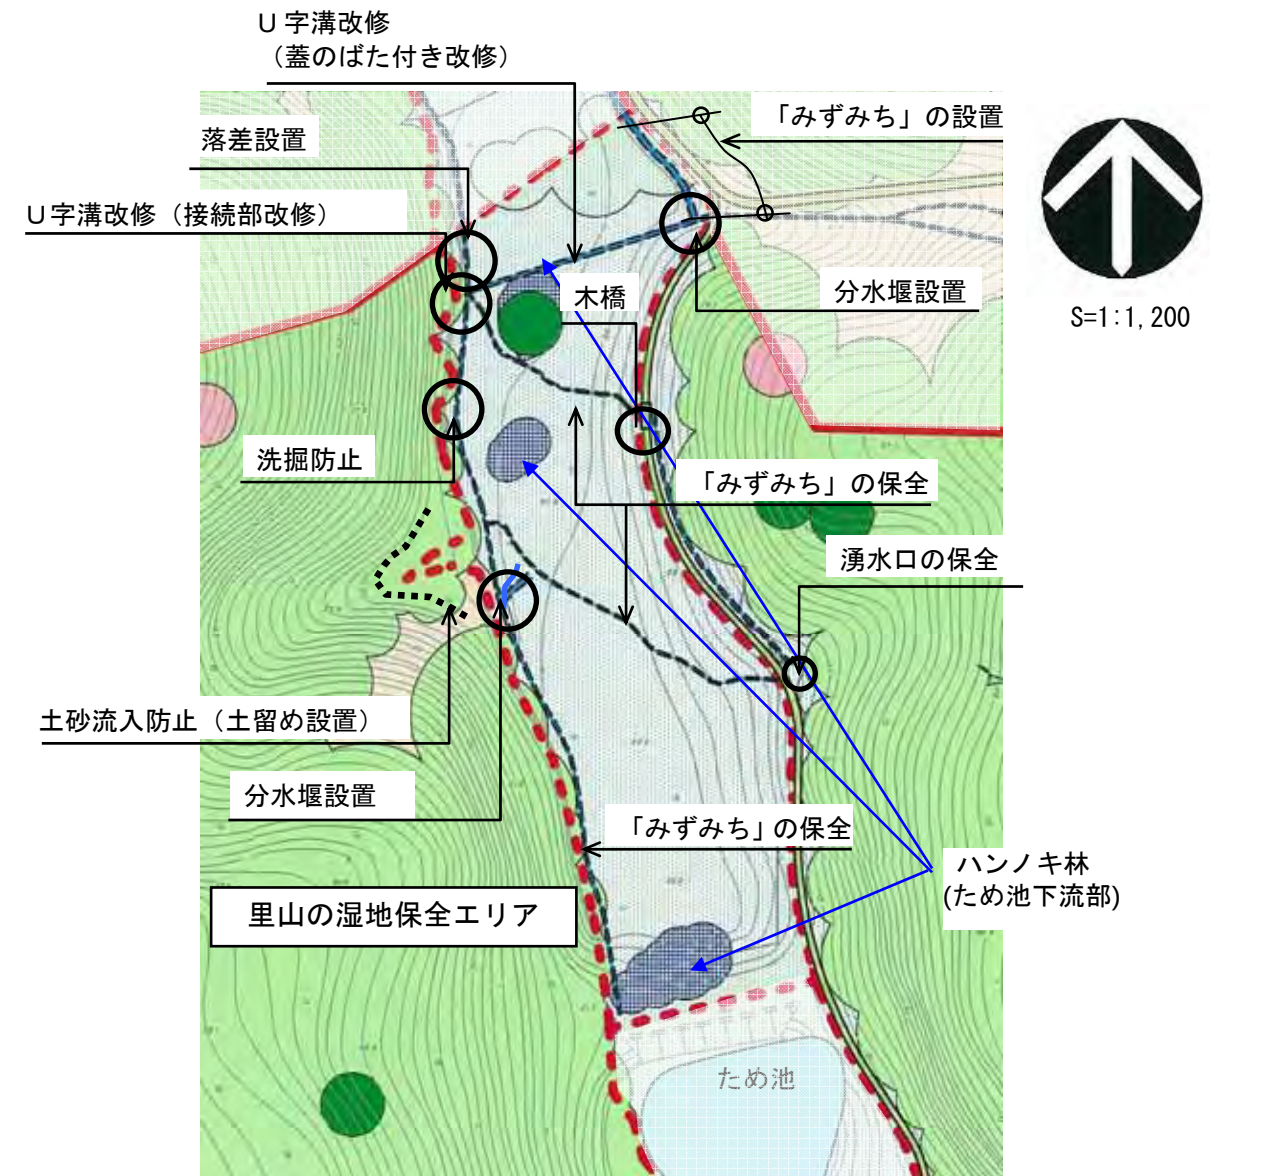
里山の湿地保全エリア 基盤整備平面図
